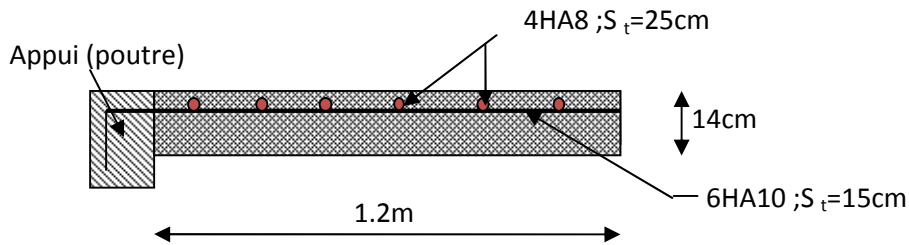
schéma de ferrailage de la dalle plein sur 3appuis.
